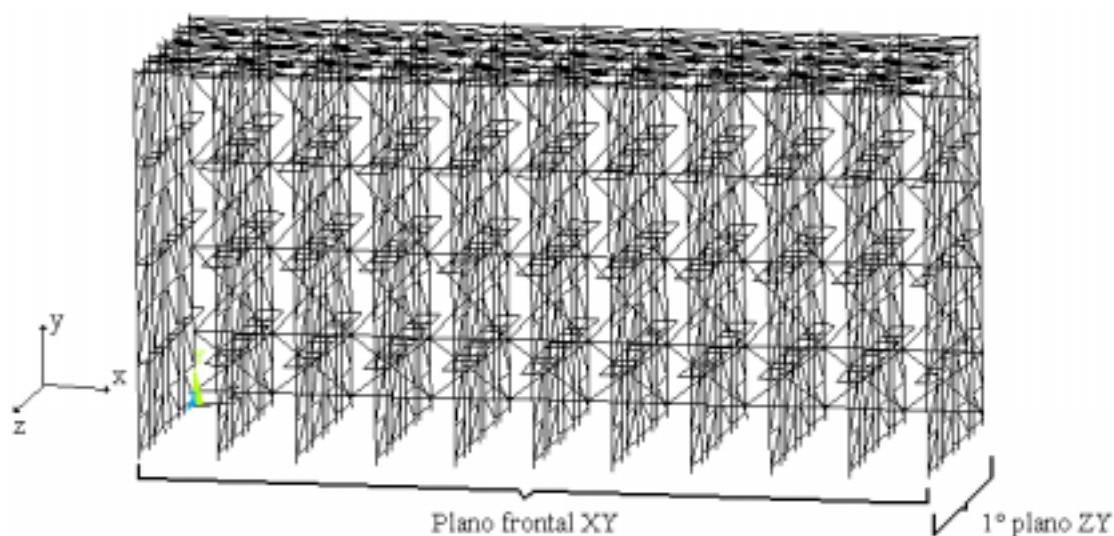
Definição dos planos de aplicação das forças horizontais.
